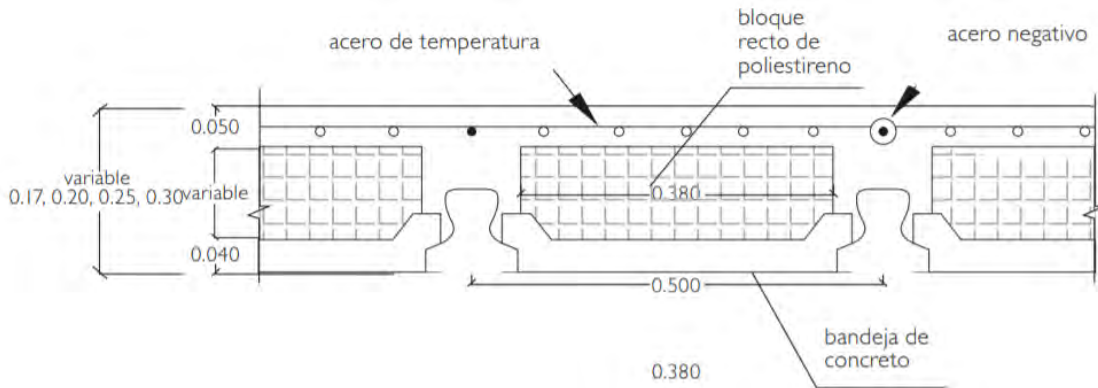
Detalle mix de bandeja de concreto con bloque de poliestireno.
